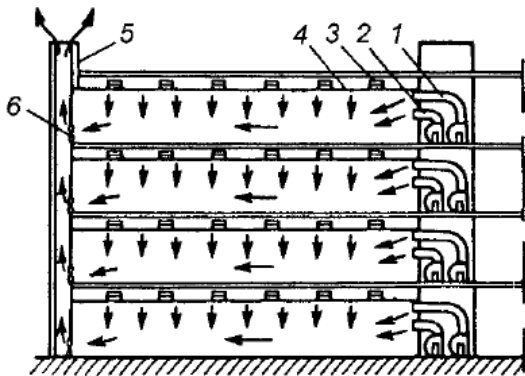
Система вентиляції багатоповерхового пташника: 1 і 2 – припливні установки; 3 – вікна для забору зовнішнього повітря; 4 – підвісна перфорована стеля; 5 – шахта; 6 – витяжні вентилятори
